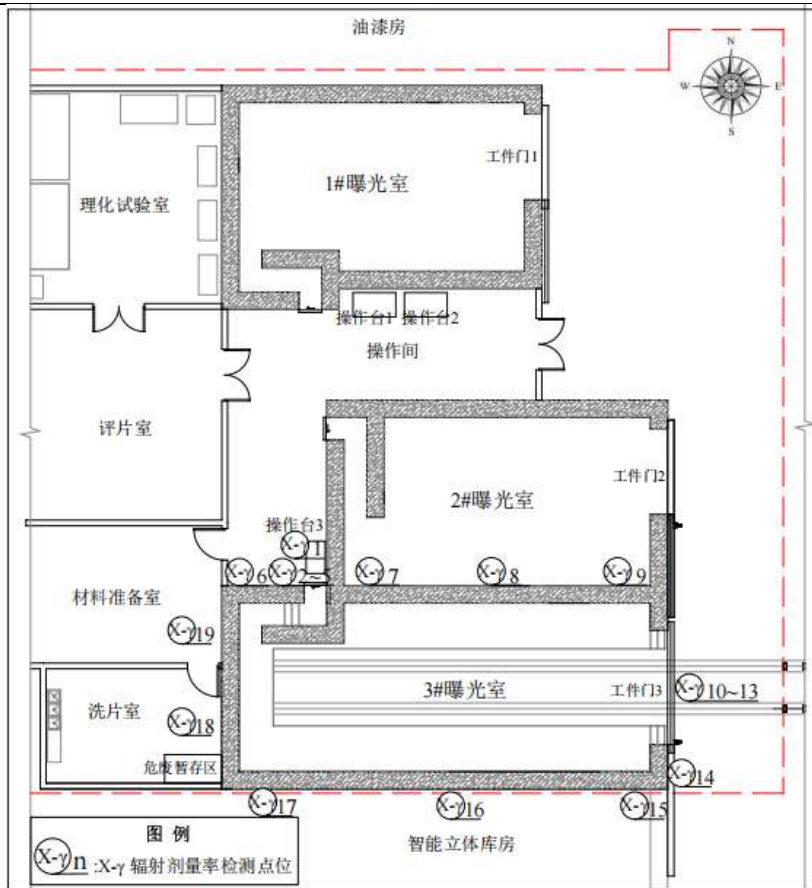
本项目 3#曝光室工作场所现场检测点位平面示意图
